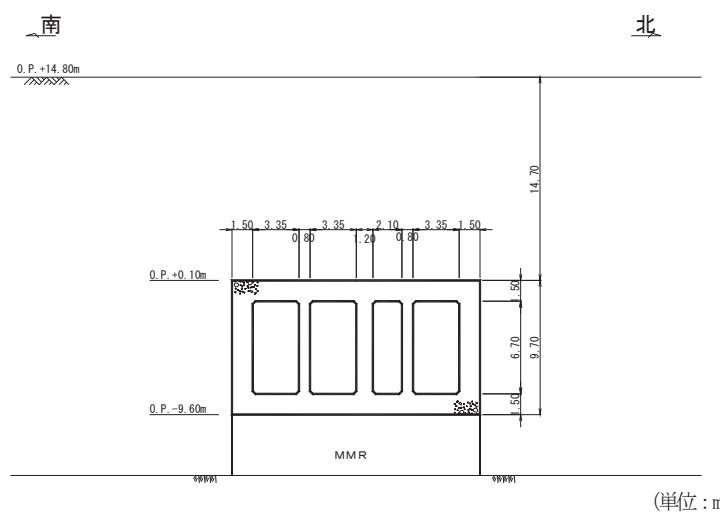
原子炉機器冷却海水配管ダクト（水平部）断面図（A-A）
